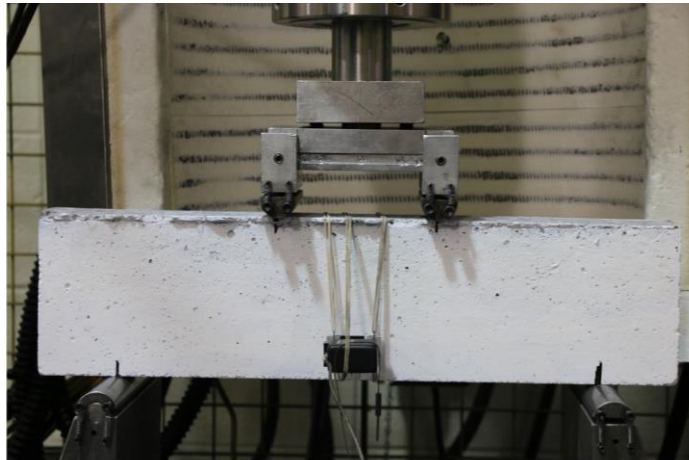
Montage expérimental pour les essais de préfissuration en quatre points sur une poutre entaillée
